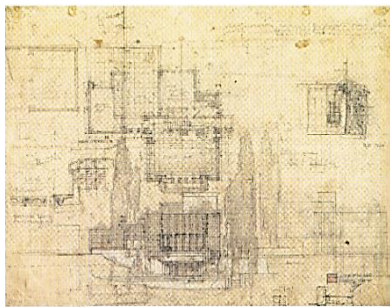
Desenho de planta e alçado do lado da entrada. (PFEIFFER B. B., 2004)
